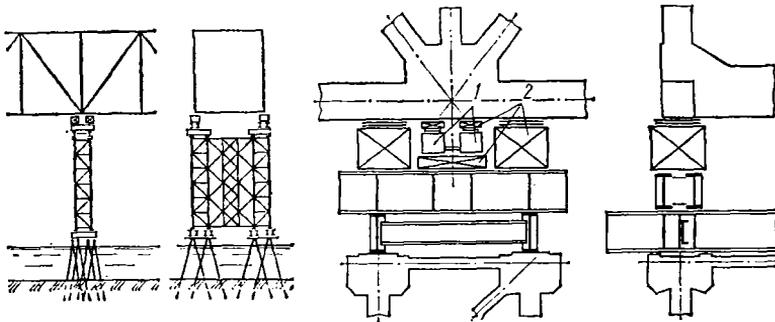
Схема вспомогательной опоры для полунавесной сборки и деталь опирания пролетного строения:
